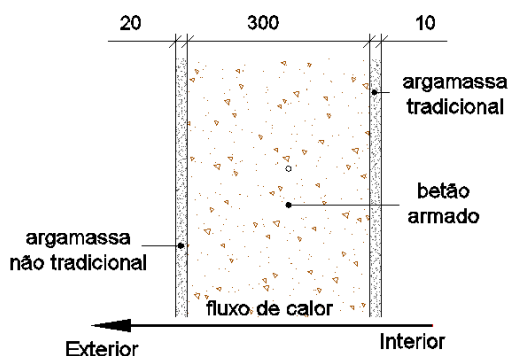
Pormenor das paredes da envolvente exterior – PE2
